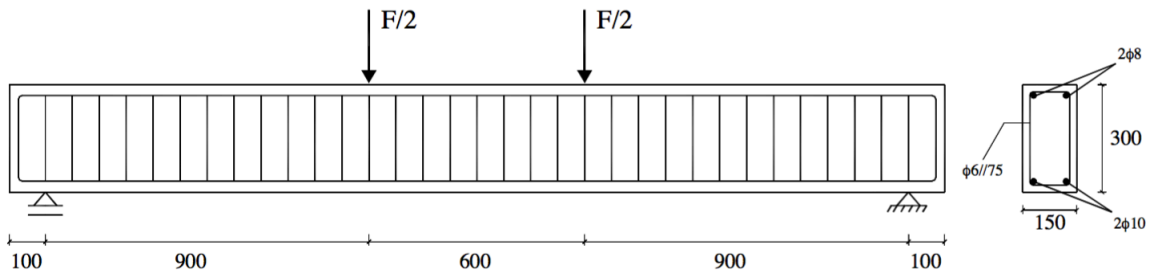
Geometria das vigas propostas (Fonte: Dias *et al*, 2012)
